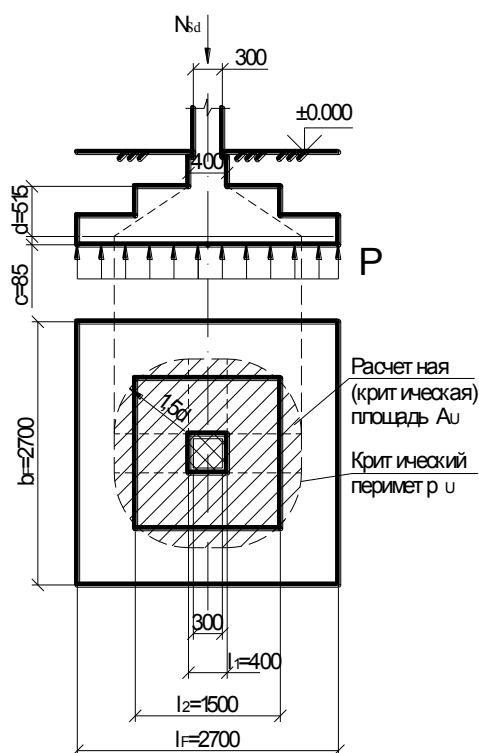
Расчетная модель столбчатого плитного центрально-нагруженного фундамента для определения прочности на продавливание
